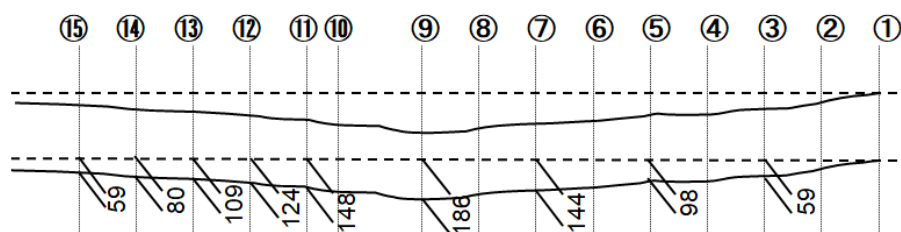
G2 桁下フランジの残留水平変位 (計測値: mm)
